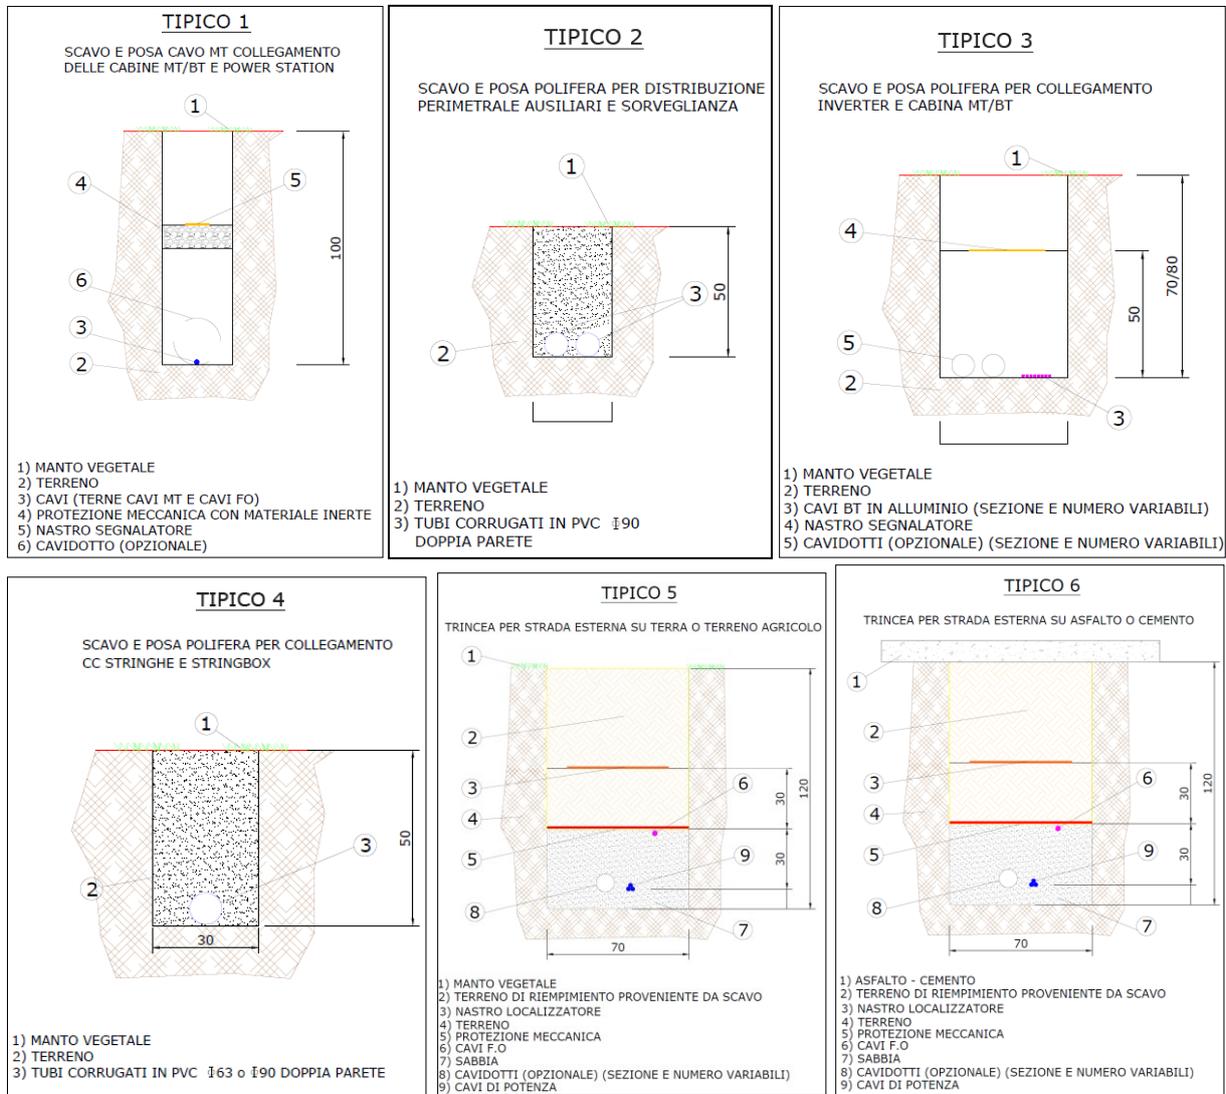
particolare dei cavi nelle aree dei parchi AV.
